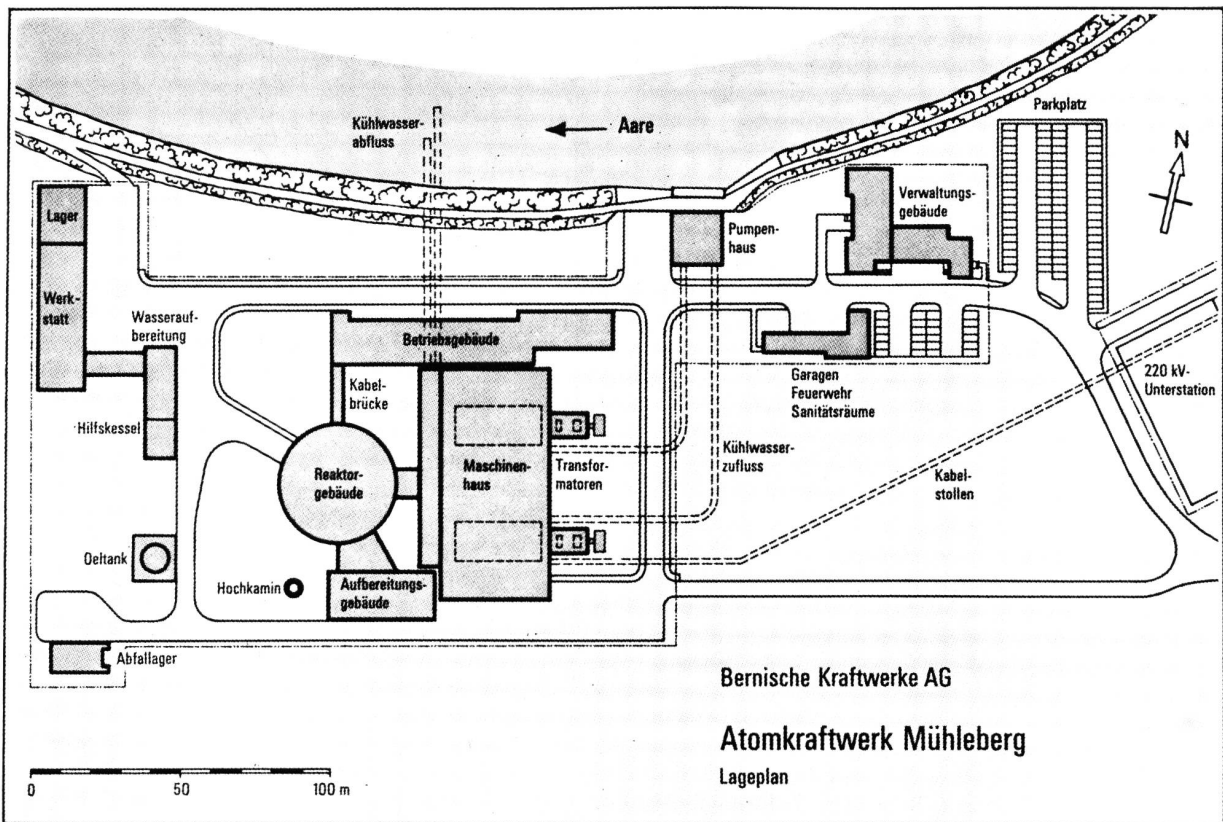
Lageplan des Kernkraftwerks Mühleberg (306 MW_e)
